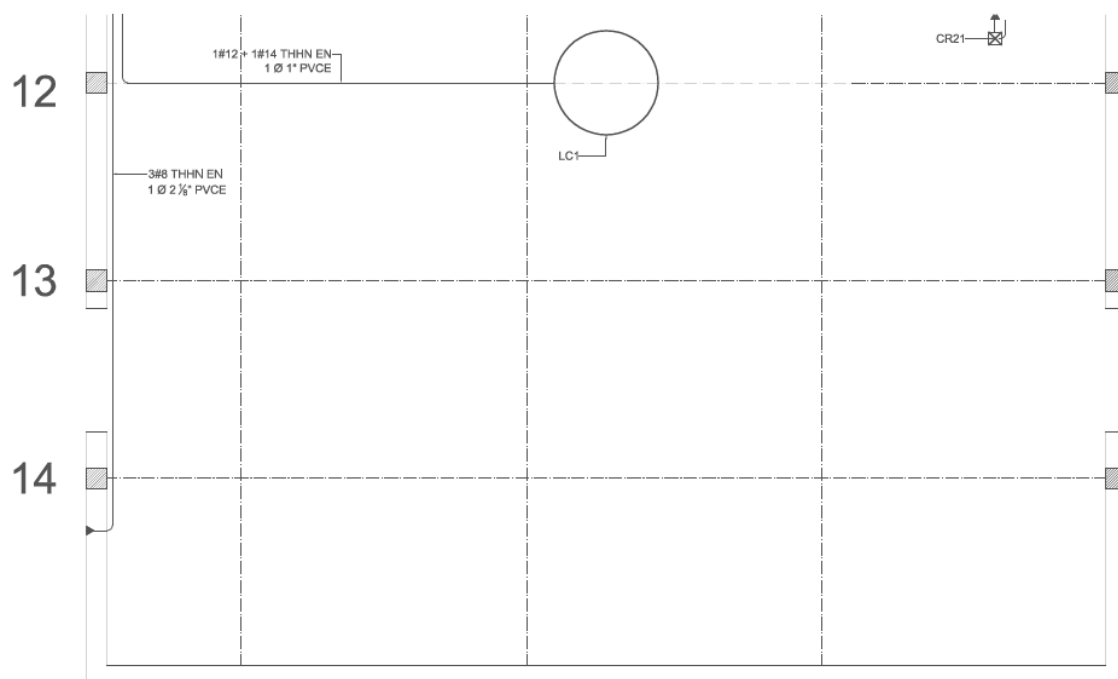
Plano de iluminación. Vista de los ejes del 12 al 14.
